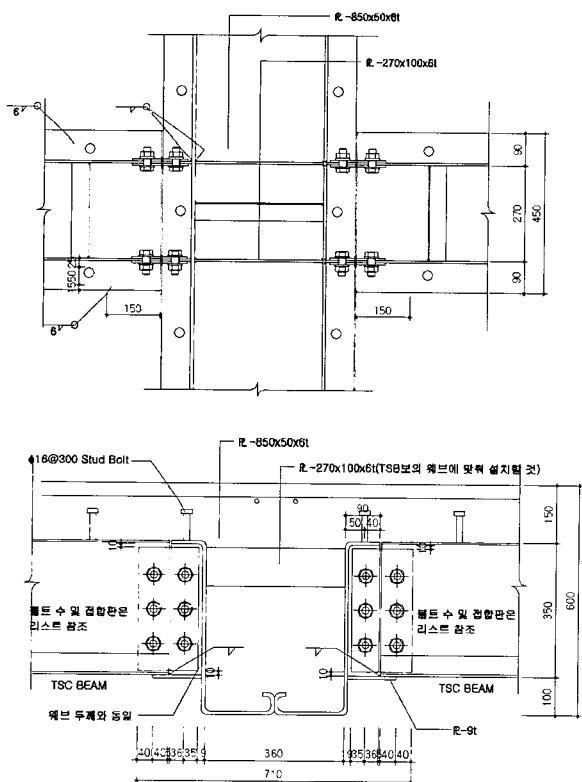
TSC Girder와 TSC Beam의 접합상세 (평면 및 단면도)
